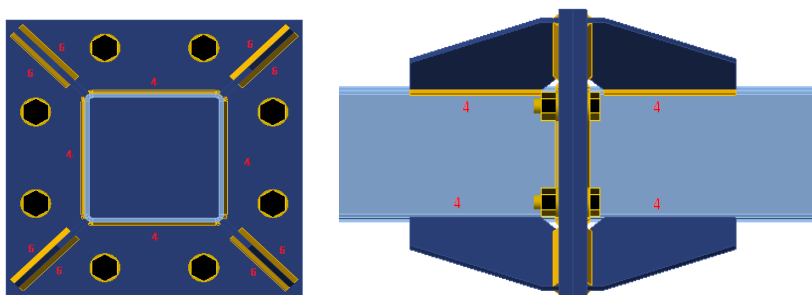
Схема катетов швов монтажного узла нижнего пояса
